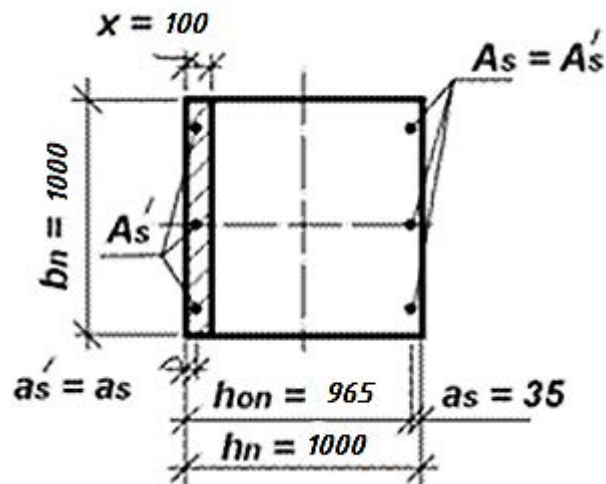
К расчету продольной арматуры подколонника к сечению 4-4
